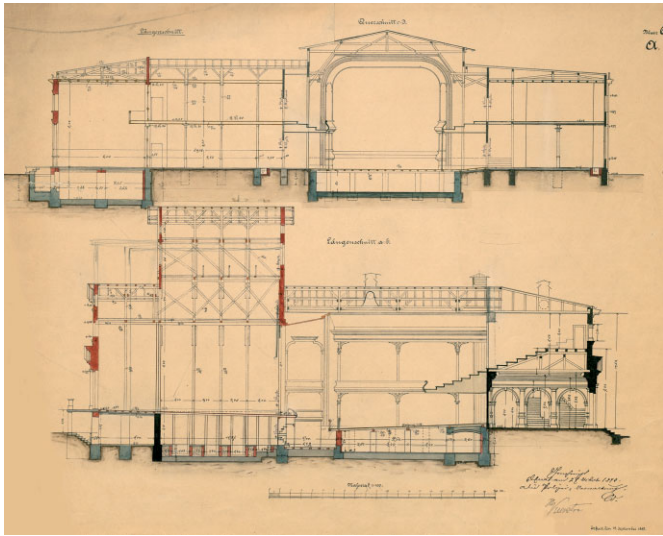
Umbau der Alten Erfurter Oper – Bauwerksplan – HERMANN KICKTON – 1893
